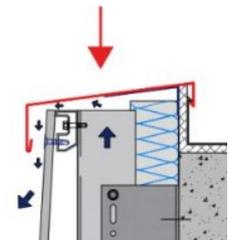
Détail de fixation de la façade ventilée à différentes dispositions
